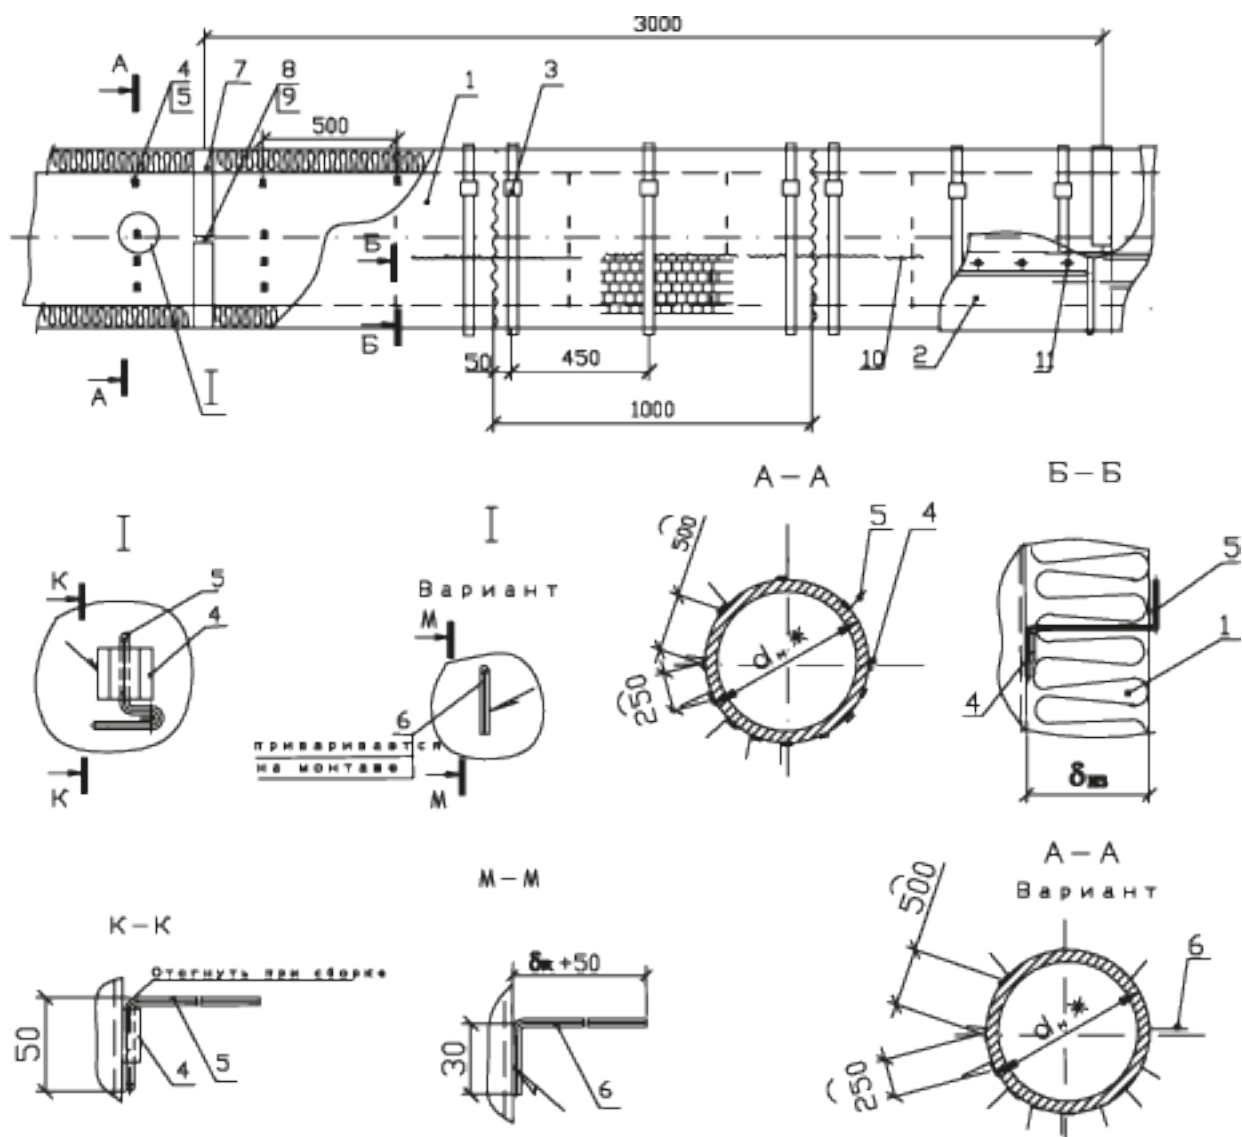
Изоляция вертикальных трубопроводов  $d_n$  от 530 мм и более плитами из минеральной ваты в два слоя с креплением бандажами и стяжками
